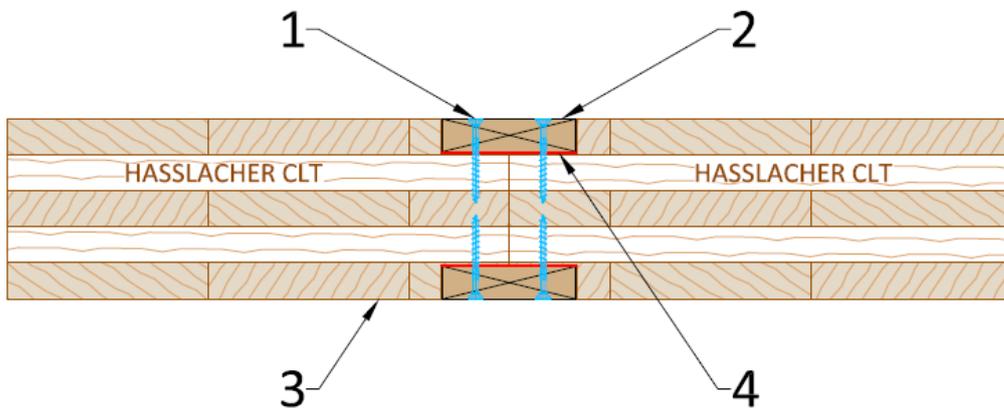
Coupe verticale, jonction de planchers par fausse-languette
